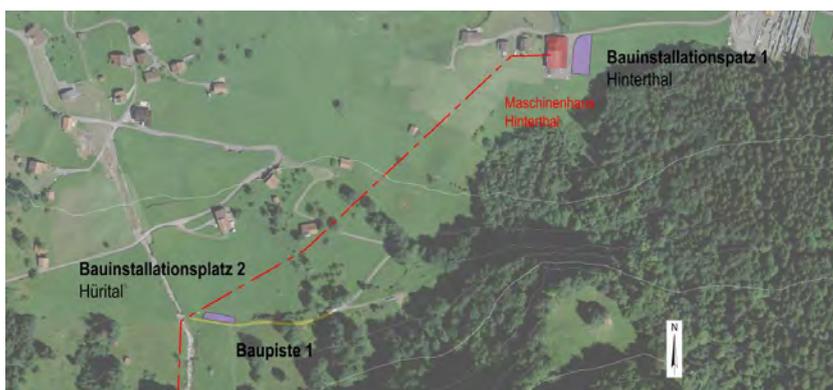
Bauinstallationsplätze 1 und 2.
